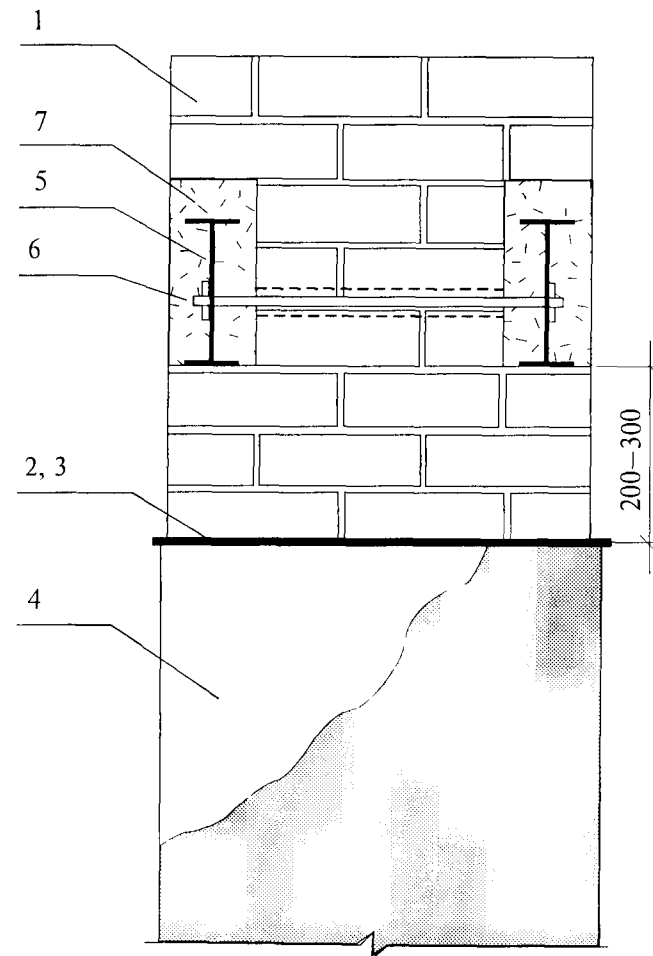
Установка разгрузочных балок в стене здания
